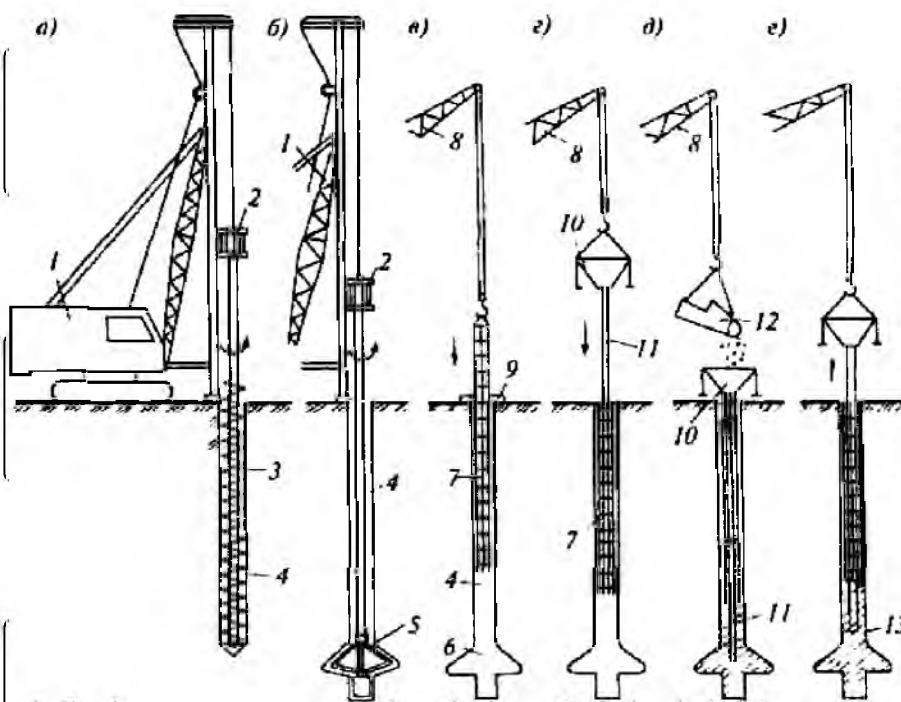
Технологічна схема влаштування буронабивних паль сухим способом: а - буріння свердловини; б - розбудовування розширенні порожнини; в - установка арматурного каркаса; г - установка бетонлітної труби з вібробункером; д - бетонування свердловини методом вертикально переміщеної труби; е - підйом бетонлітної труби; 1- бурова установка; 2 - привід; 3 - шнековий робочий орган; 4 - свердловини; 5 - розширювач; 6 - розширена порожнина; 7- арматурний каркас; 8 - стріловидний кран; 9 - кондуктор-патрубок; 10 - вібробункер; 11 - бетонлітна труба; 12 - бадді з бетонною сумішшю; 13 - розширена п'ята палі
